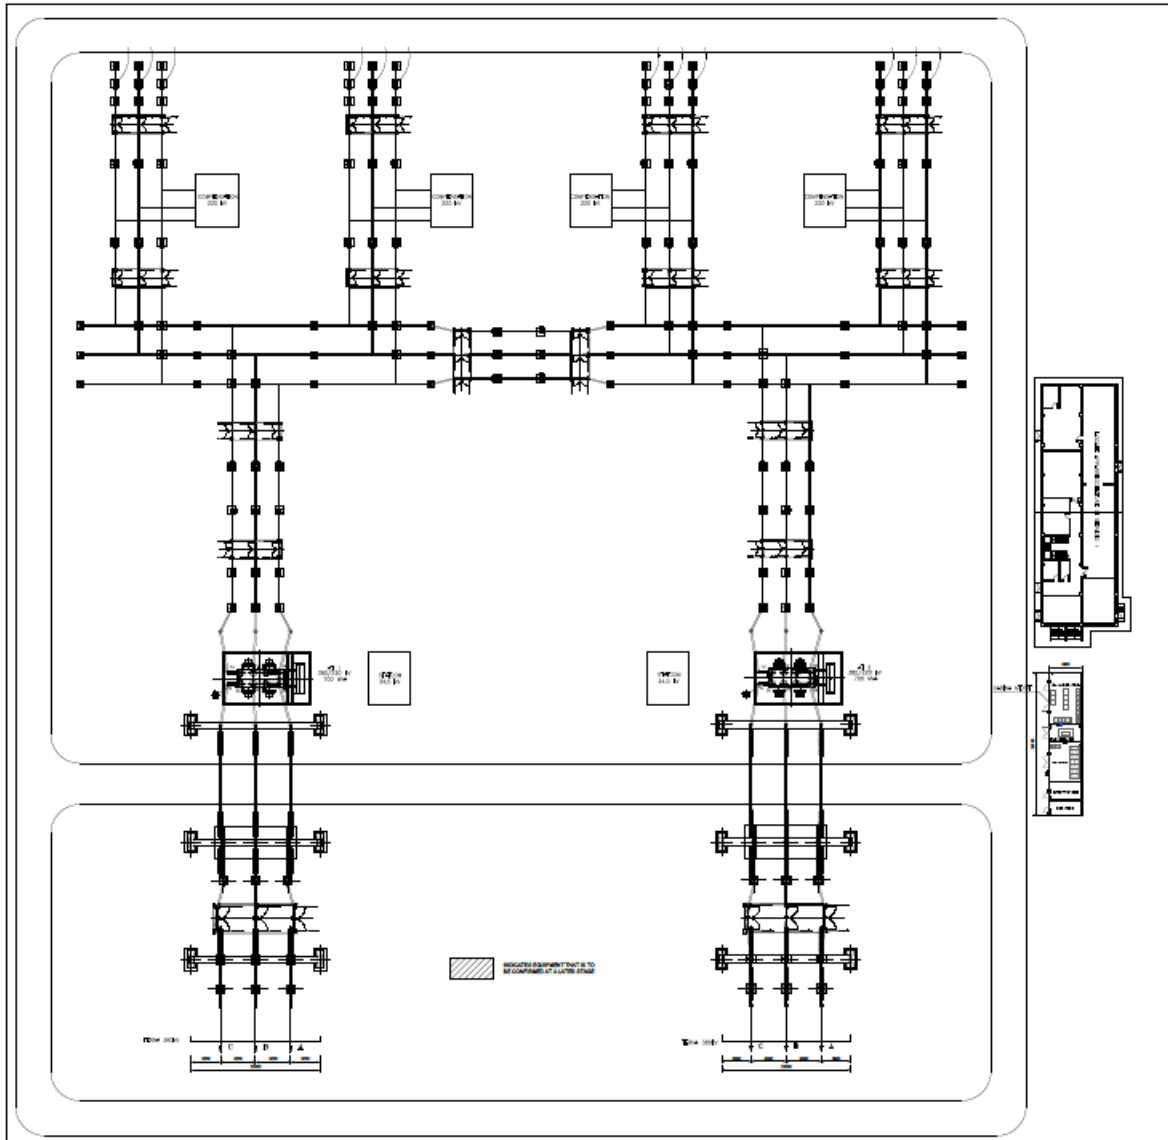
Vista in pianta della Stazione Elettrica di Utente
